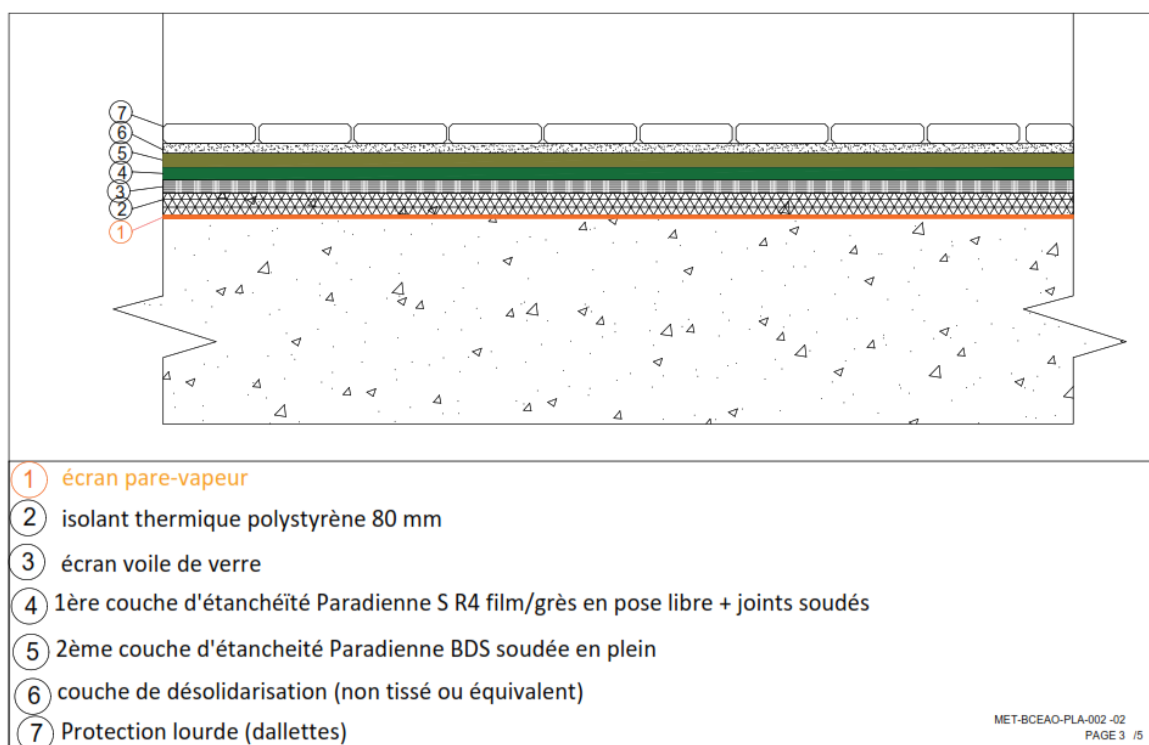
principe d'étanchéité en zone courante des locaux chauffés
